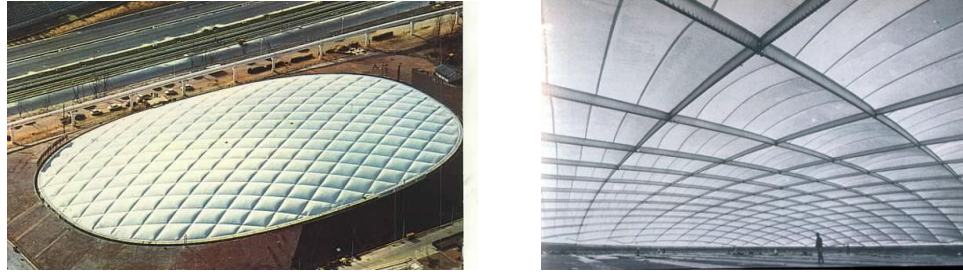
Amerikan Pavyonu'nun, yenilenen yapısının şekli (The Pavilion wars, 2009)
